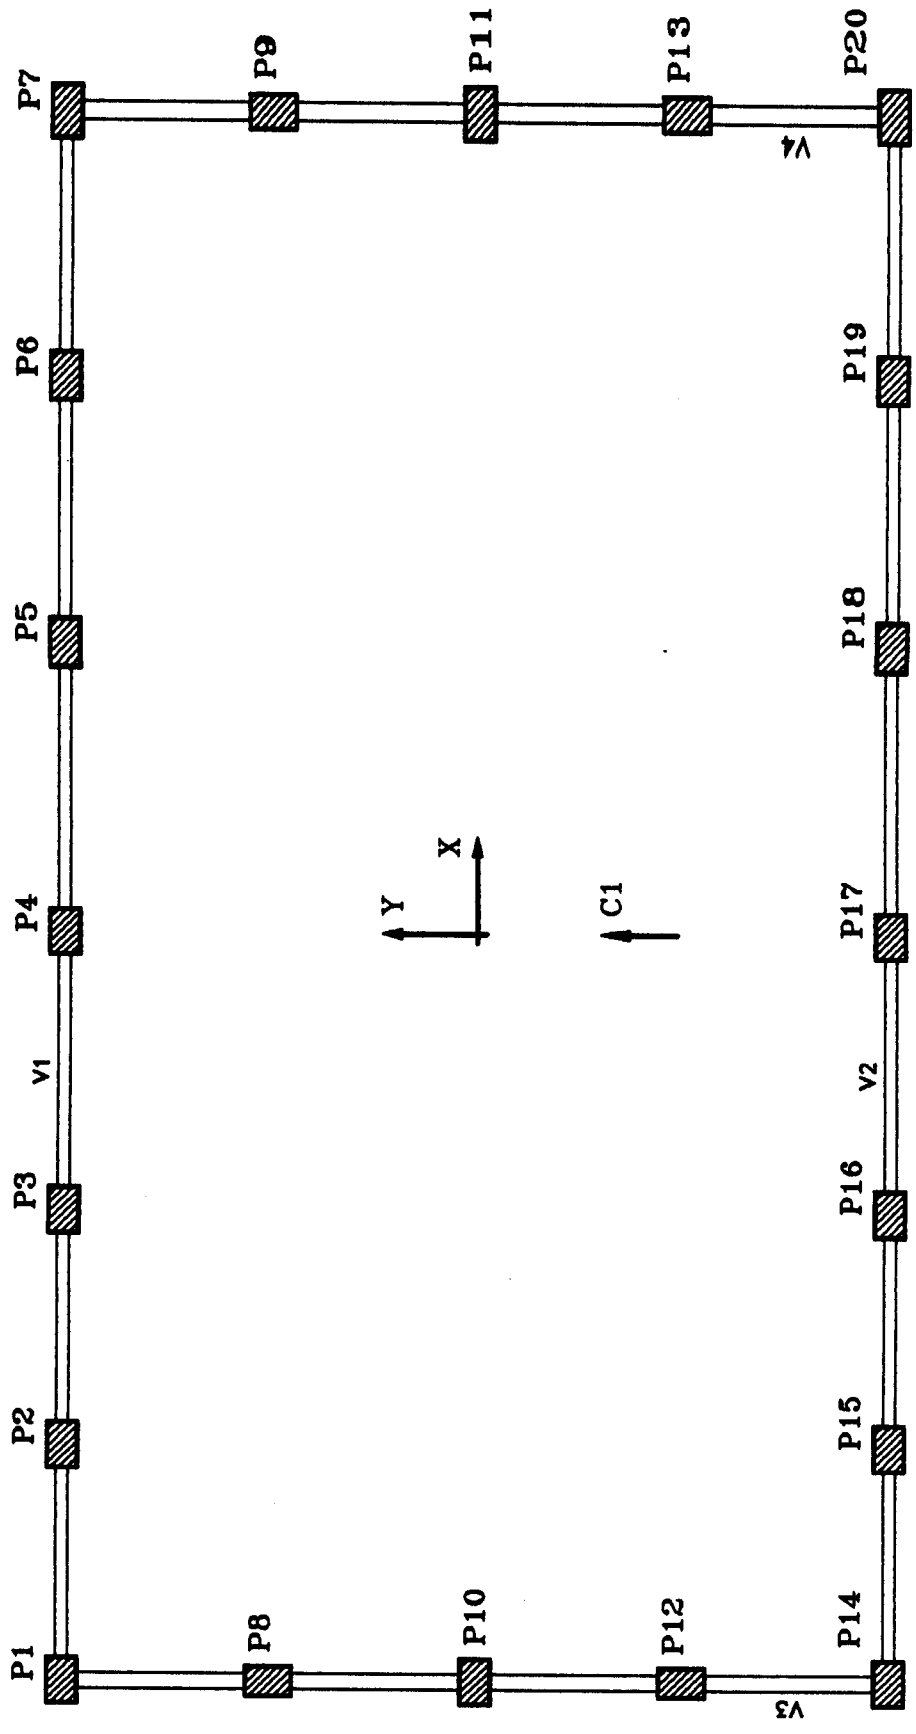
Edifício Garagem - Planta do Pav. Tipo
